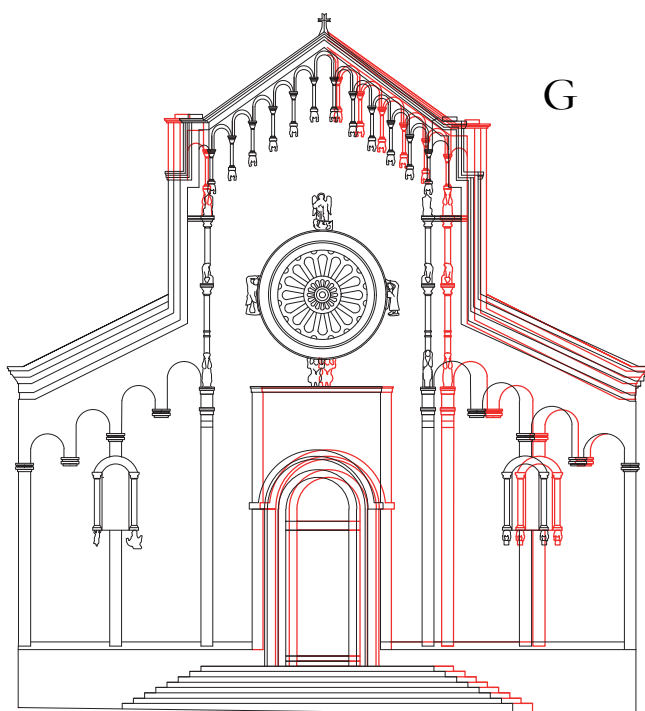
Il prospetto attuale, in nero, sovrapposto all'ipotetico prospetto originario e simmetrico, in rosso
